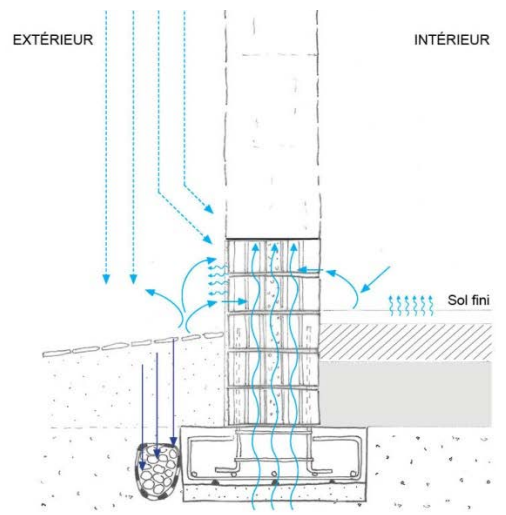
Fondation BA, soubassement\* en briques isolés, sol en pierre sur sable, géotextile/gravier
